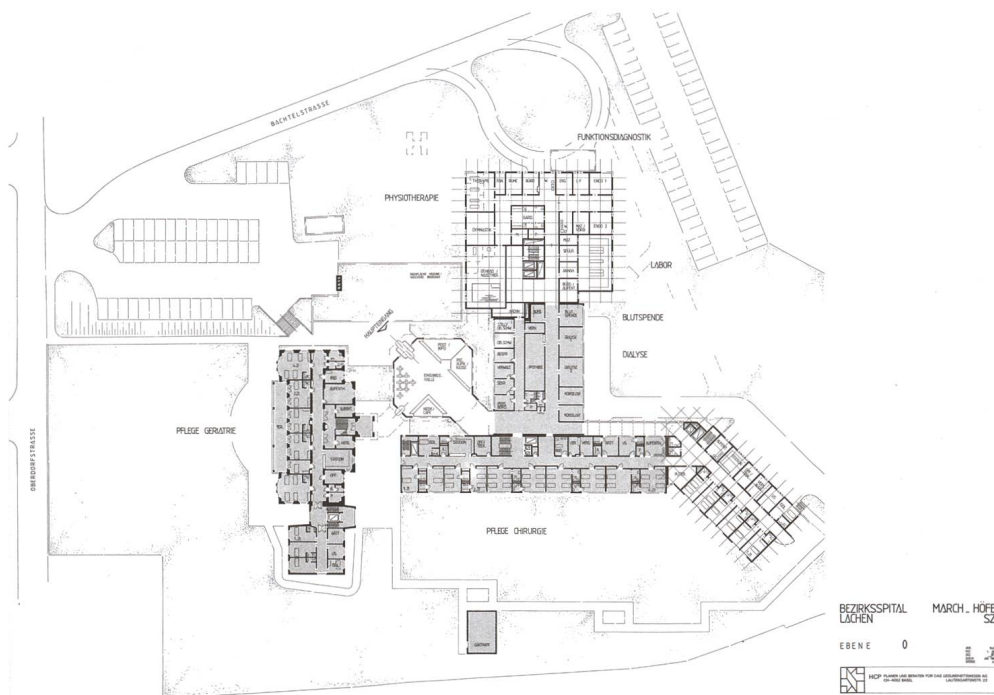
Bezirksspital March-Höfe, Lachen, Grundriss Erdgeschoss (nicht umgesetzt), 1986. Das auf Spitalbau spezialisierte Planungsbüro Health Care Consulting and Planning (HCP) in Basel wurde mit der Erstellung eines Um- und Ausbaukonzepts für das Spital Lachen beauftragt.
